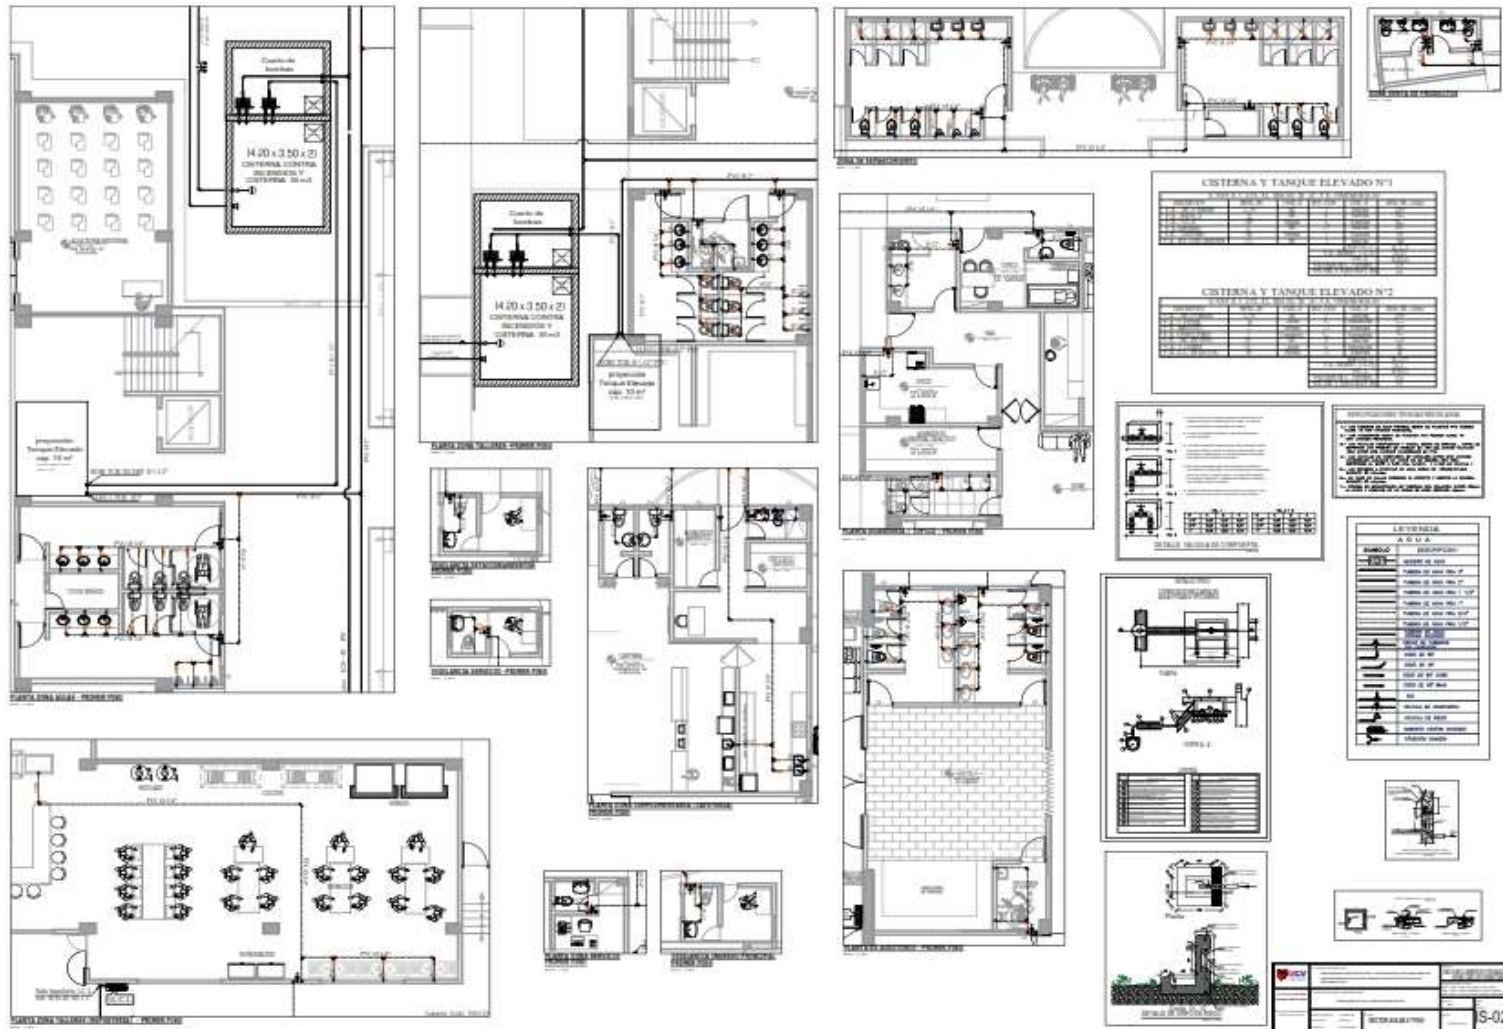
Plano de diseño de instalaciones de agua en detalles – Lamina IS-02
